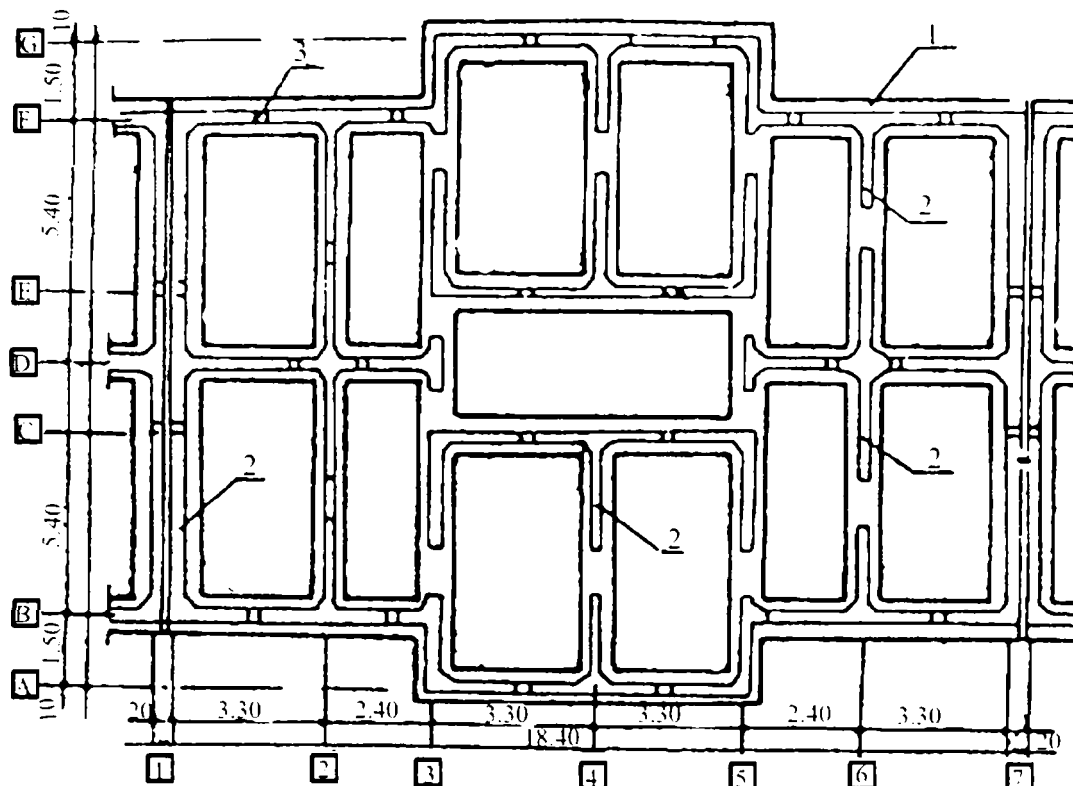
Planul de montaj al elevațiilor spațiale: 1 - talpa monolită, 2 - elemente spațiale pentru elevații, 3 - monolitizare.
